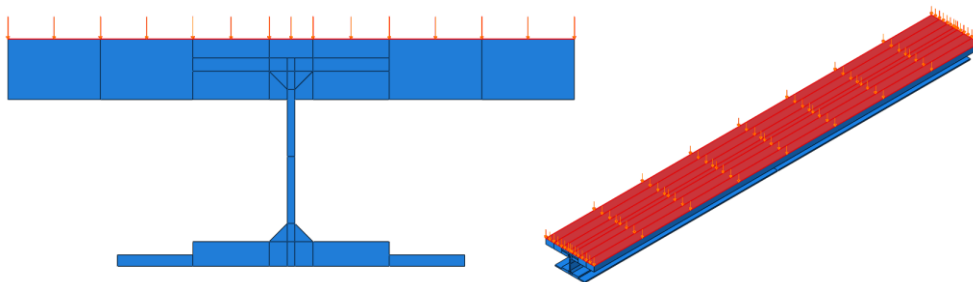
Carga aplicada na viga SFB do pavimento com 30 cm de espessura.
